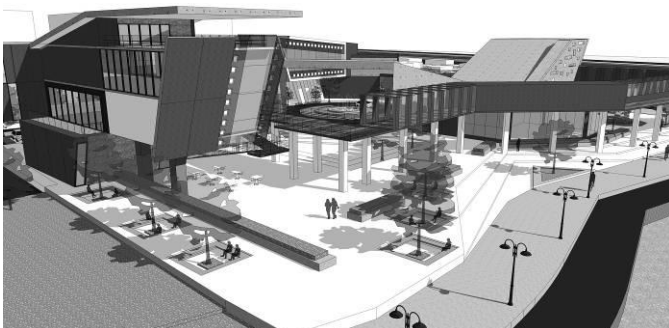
Elemen aristektur yang membentuk bingkai
